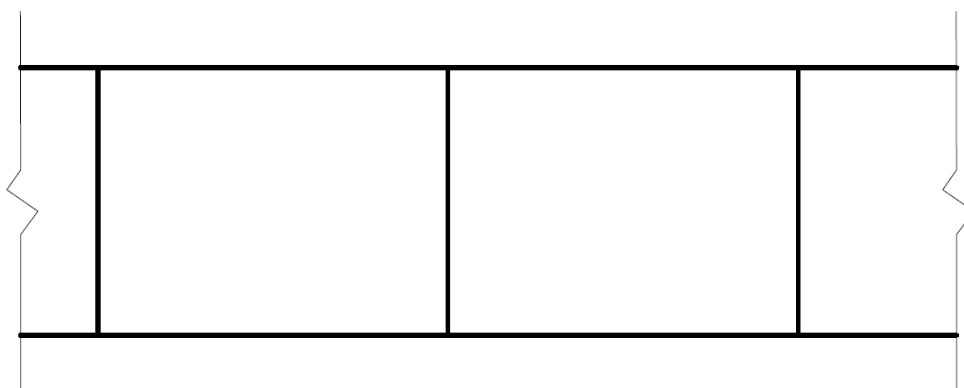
Corte longitudinal do modelo de cálculo da viga Vierendeel.
